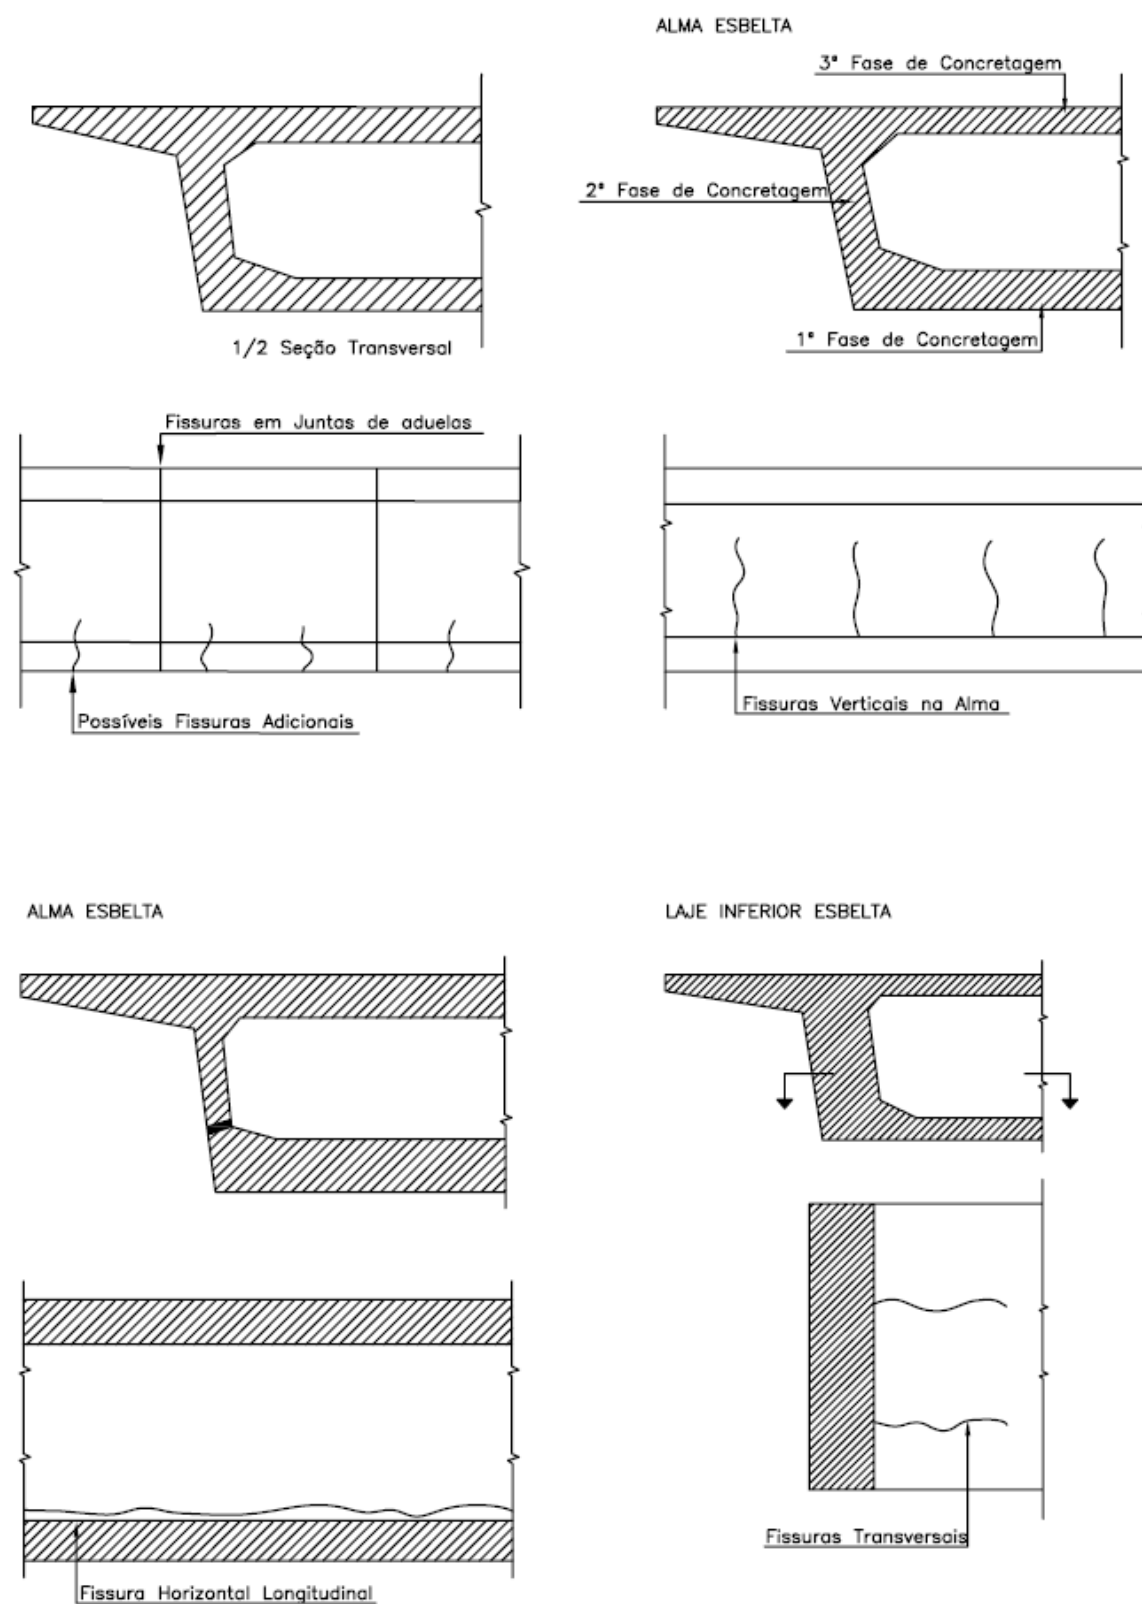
Fissuras nas vigas de concreto protendido:
